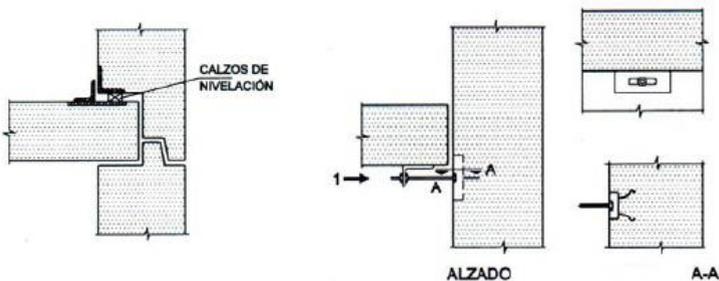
Unión mecánica entre los paneles prefabricados de hormigón y forjados.
